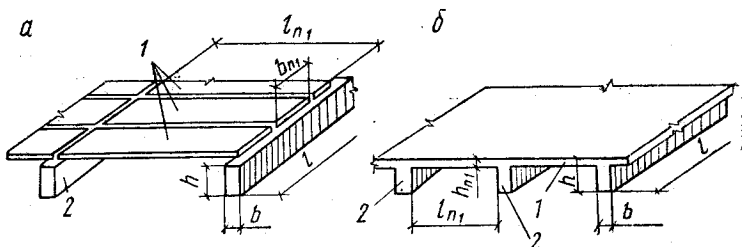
Схемы перекрытий из железобетонных элементов
